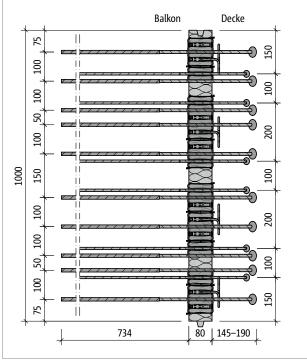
Schöck Isokorb® T Typ KL-O-M4: Produktgrundriss
